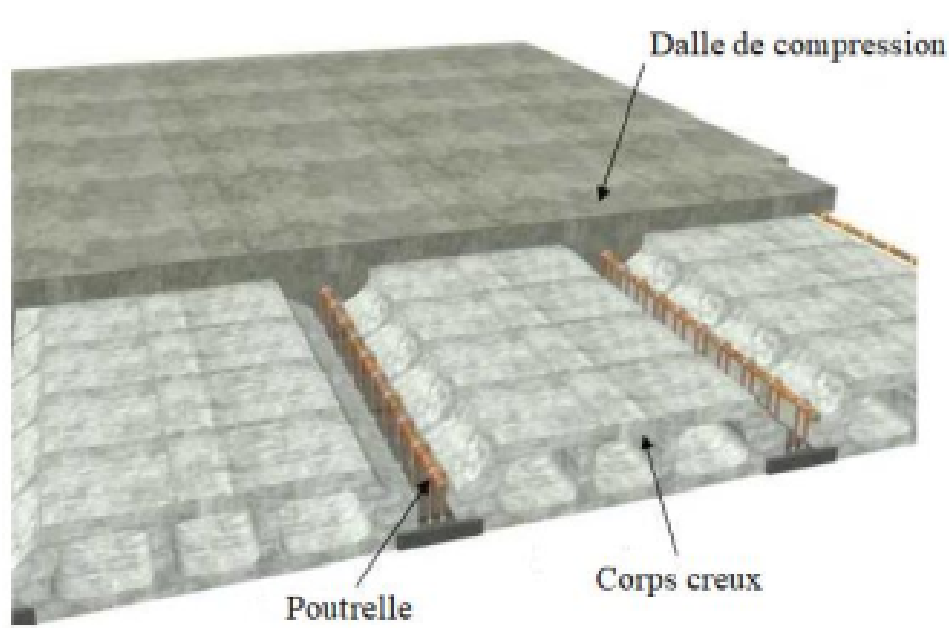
Dessin 3D d'un plancher en corps creux.
